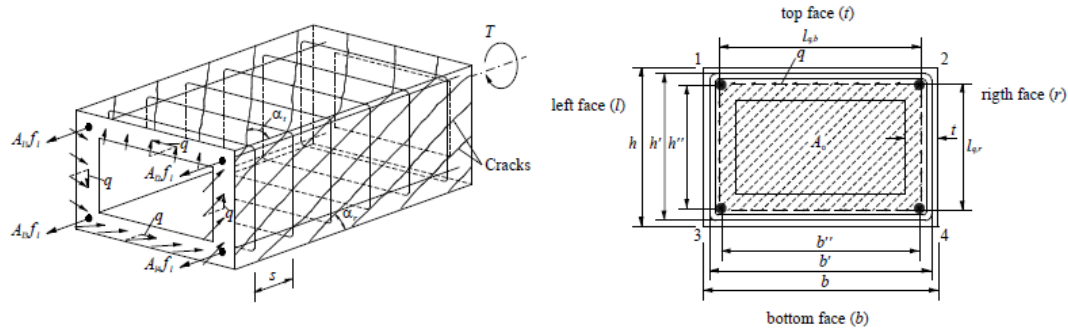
Viga com secção retangular vazada sujeita à torção [35]
